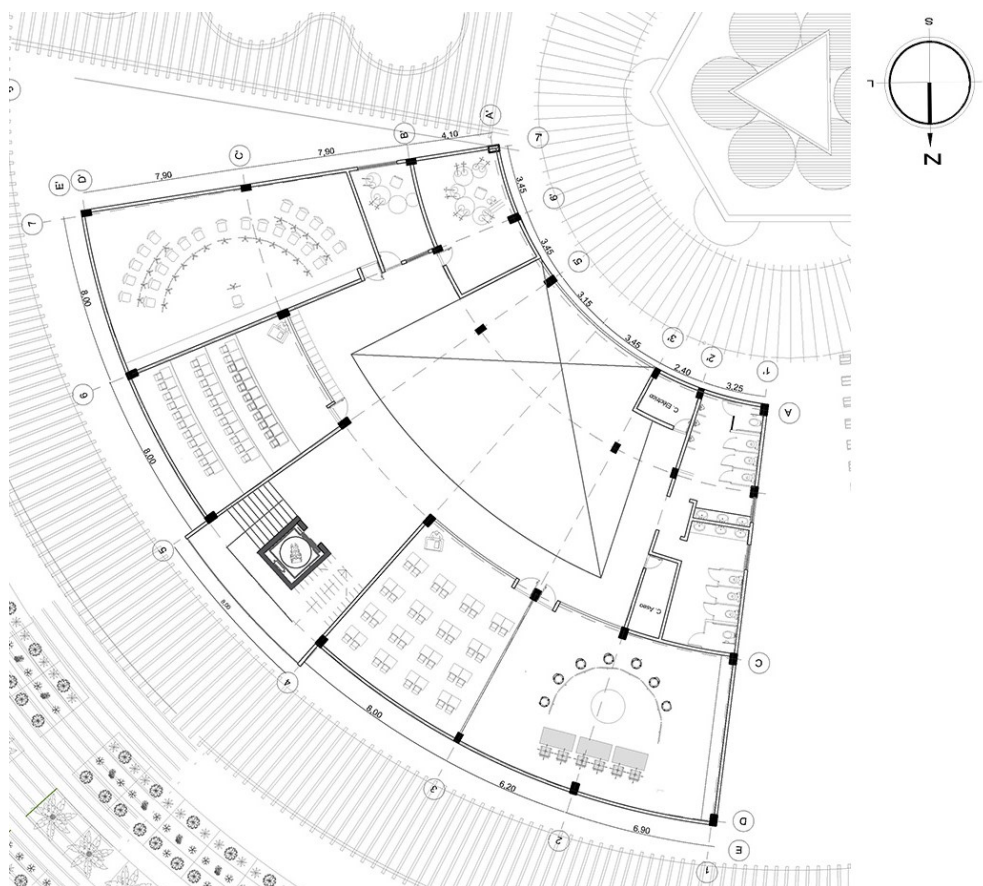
Planta 1er piso bloque de Artes. Fuente: Elaboración propia.
